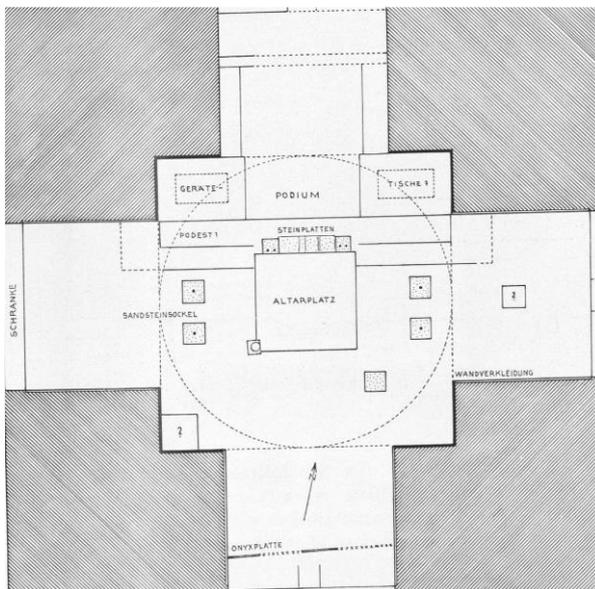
Grundriss von Raum A. Rekonstruktion⁴⁶²
